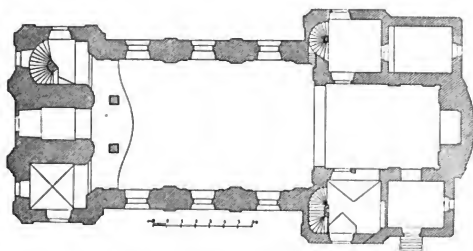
Radnitz. Pfarrkirche. Grundriss.
